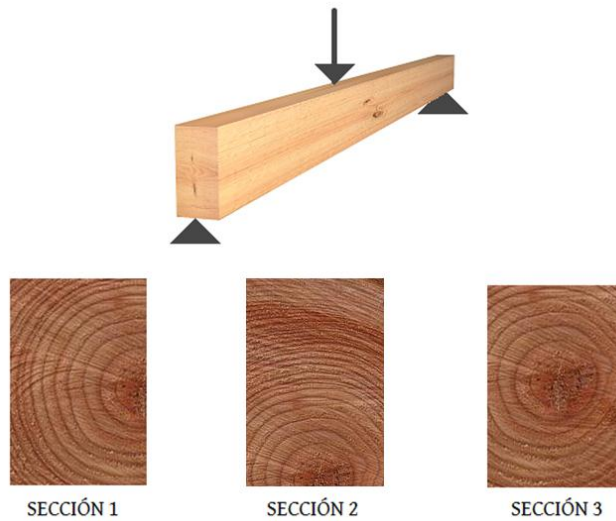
Disposición de la médula en una viga que trabaja a flexión.
